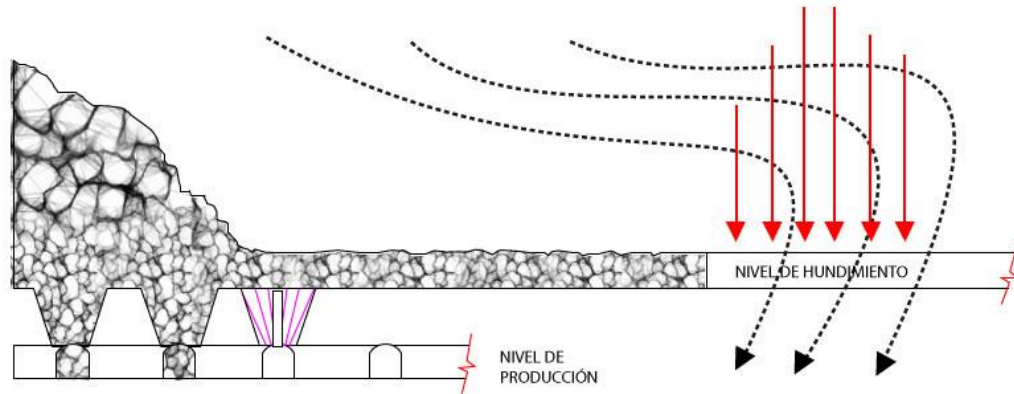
Estado tensional en Hundimiento Previo. (Modificado de Cavieres, 1999)
